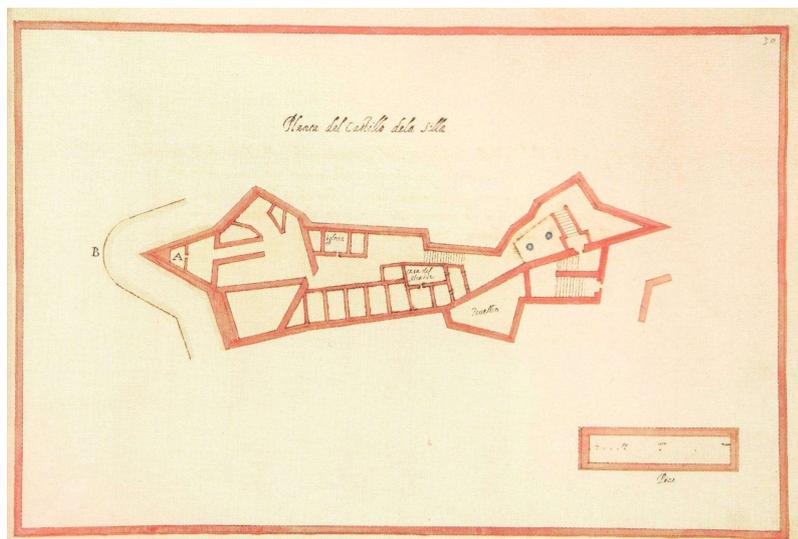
Planta del fuerte de Santa Cruz de 1594 de Leonardo Turriano (Cámara, A. Moreira, R. Viganò, M. 2010)<sup>460</sup>
